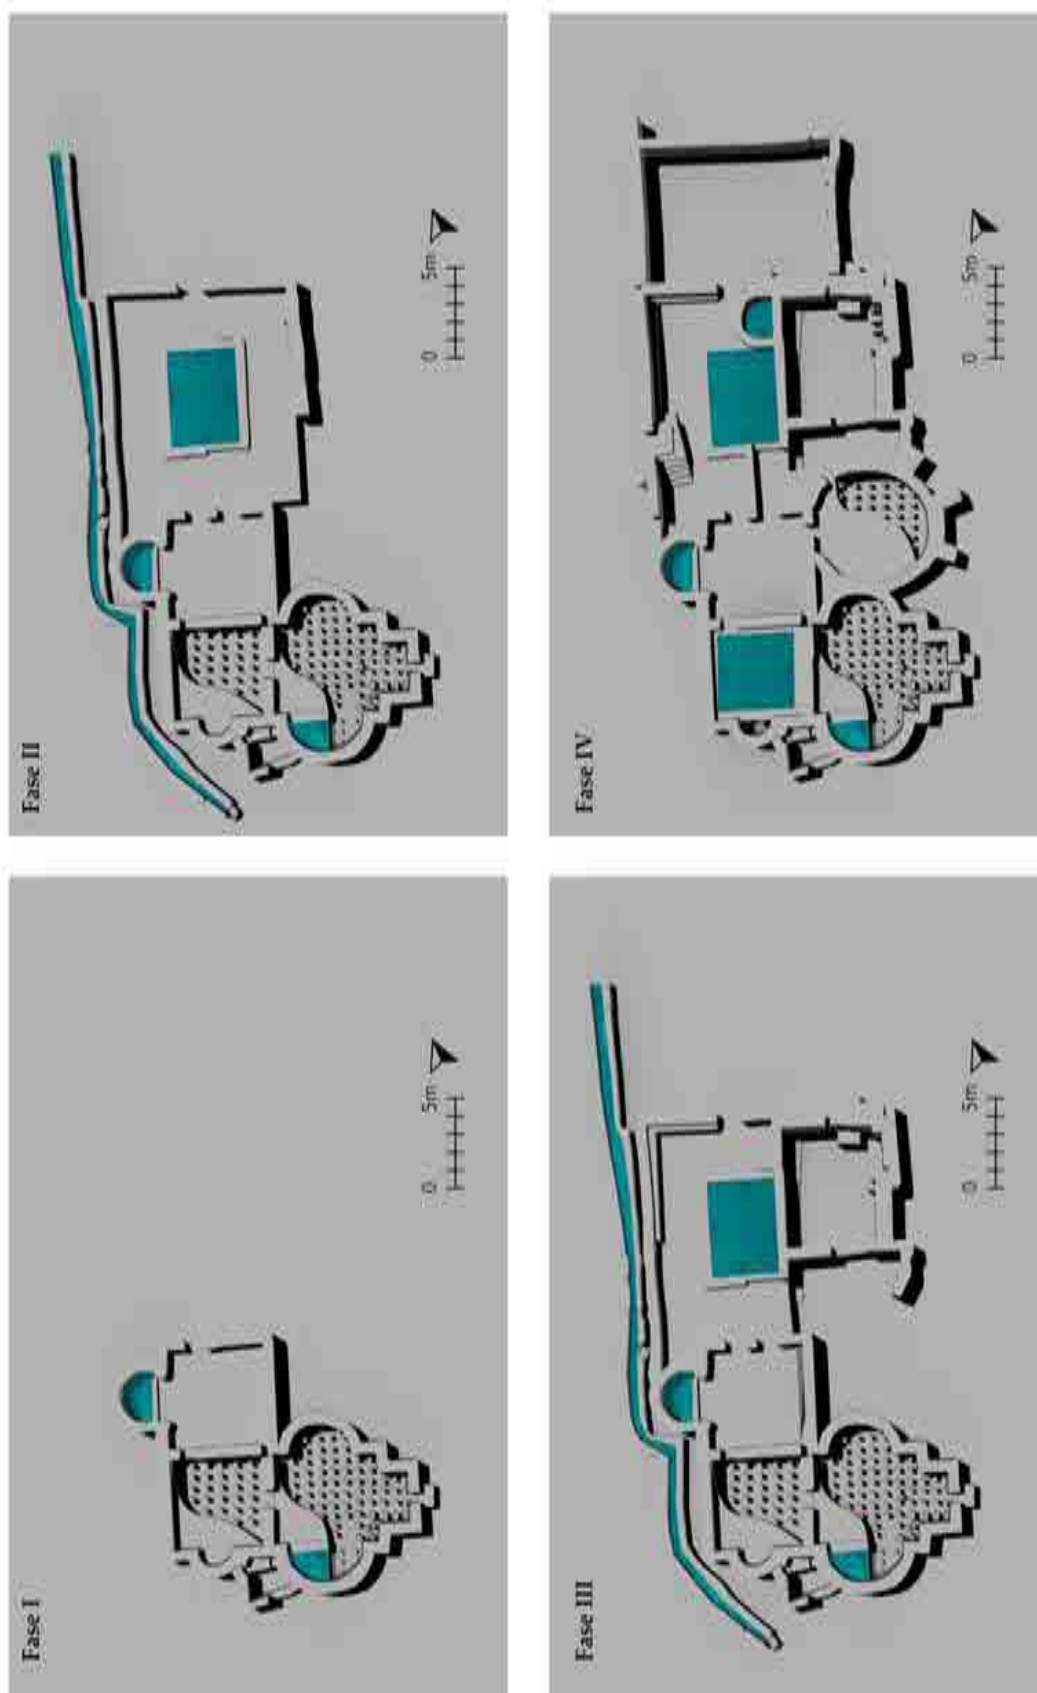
Planimetria concettuale delle principali fasi edilizie.
